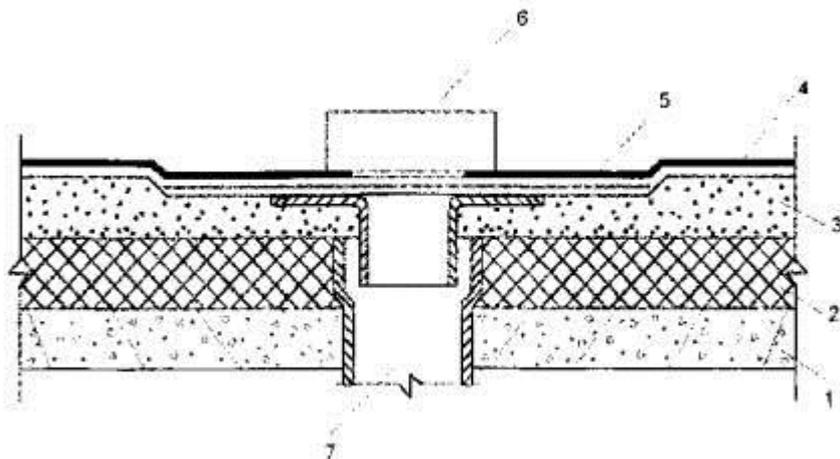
Примыкание водоизоляционного ковра к водоприемной воронке
